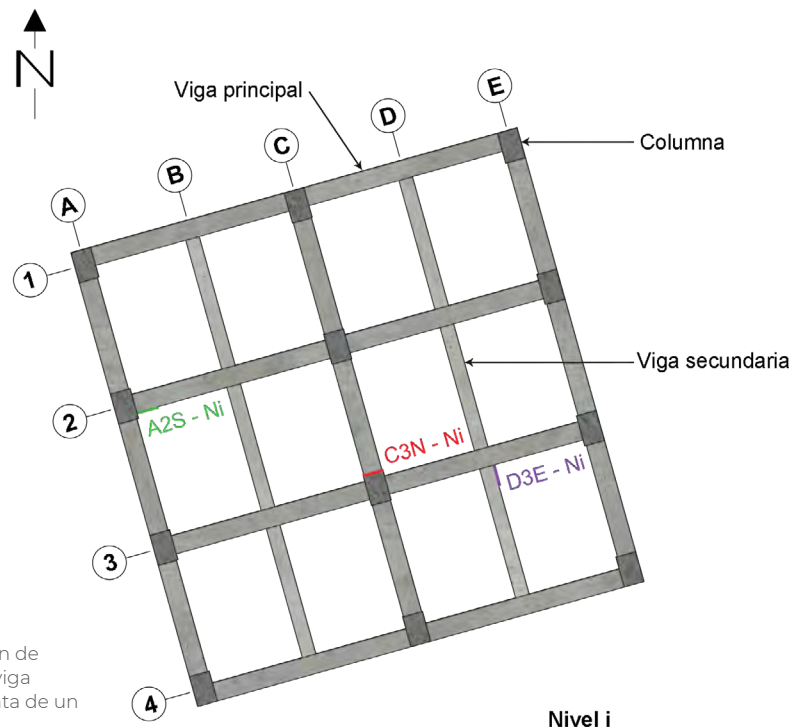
Ejemplos de identificación de elementos estructurales (columna, viga principal, viga secundaria) en la planta de un edificio cualquiera en el nivel i.
